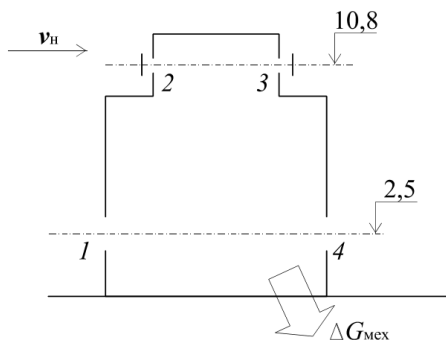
Вертикальный разрез здания и схема связей помещения с наружным воздухом: 1 и 4 – приточные отверстия; 2 и 3 – вытяжные отверстия; $\Delta G_{мех}$ – дебаланс воздуха, создаваемый вентиляционными системами с механическим побуждением движения воздуха
